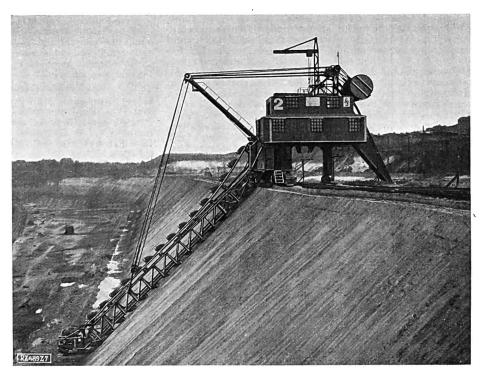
bis 10 zeigen den Bagger nach Abb. 7 für Dampfantrieb. Zum Antrieb sämtlicher Getriebe dient eine stehende Verbund-Dampfmaschine von 290/440 mm Zylinder-Dmr. und 320 mm Kolbenhub bei rd. 225 Uml./min. Die Steuerung wird durch einen Achsenregler beeinflußt, so daß sparsamster Dampfverbrauch gewährleistet ist. Der Dampf wird in einem lieen-
